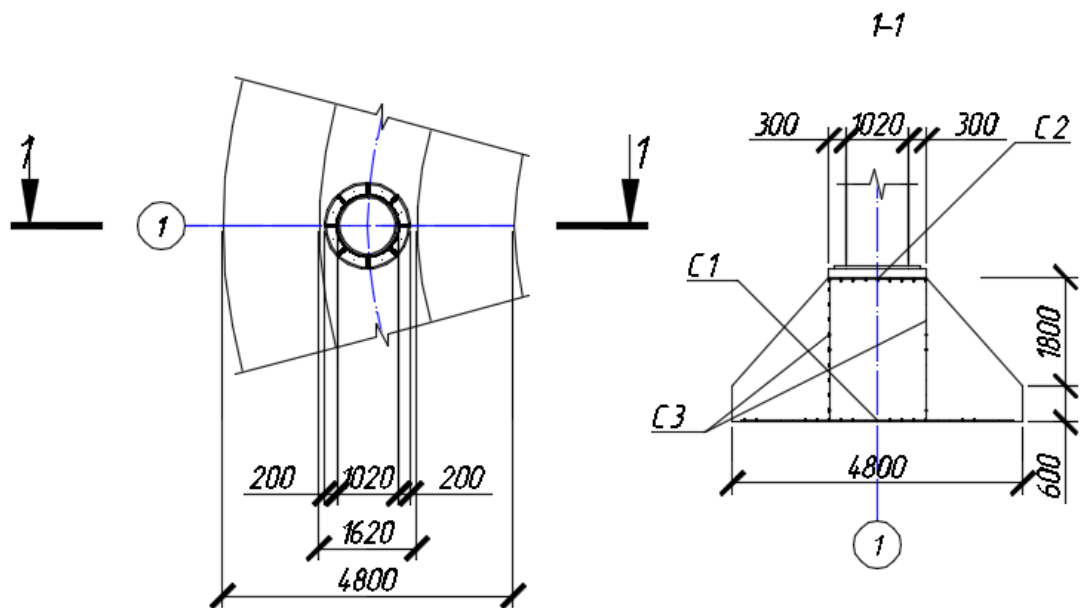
Кольцевой фундамент под ствол башни
